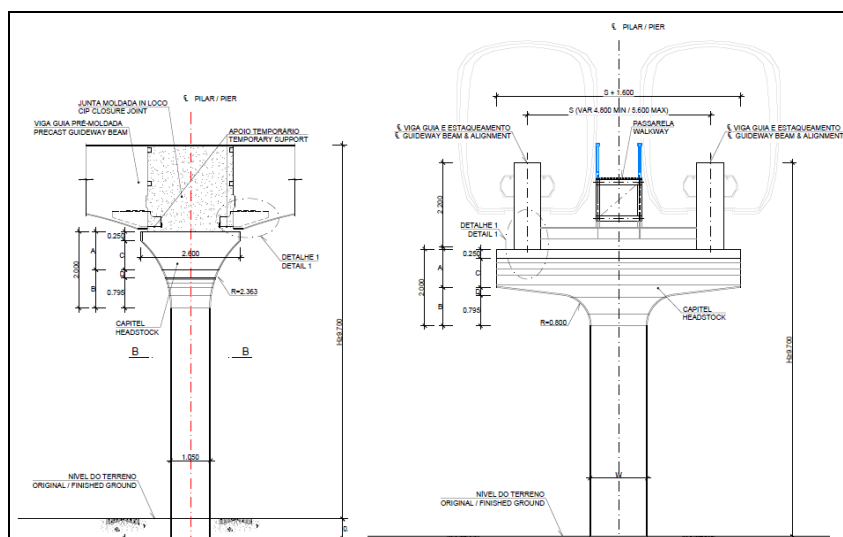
Forma Estrutura Via Elevada Tipo 1B (Planta DE-MG.00.EL\_C.EC2-008).
